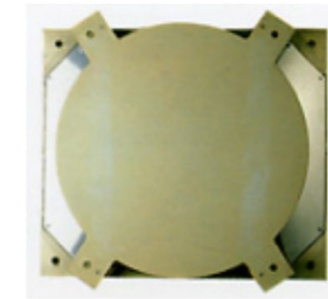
Vista en planta del apoyo elastomérico. Fuente: Mekanogumba.
